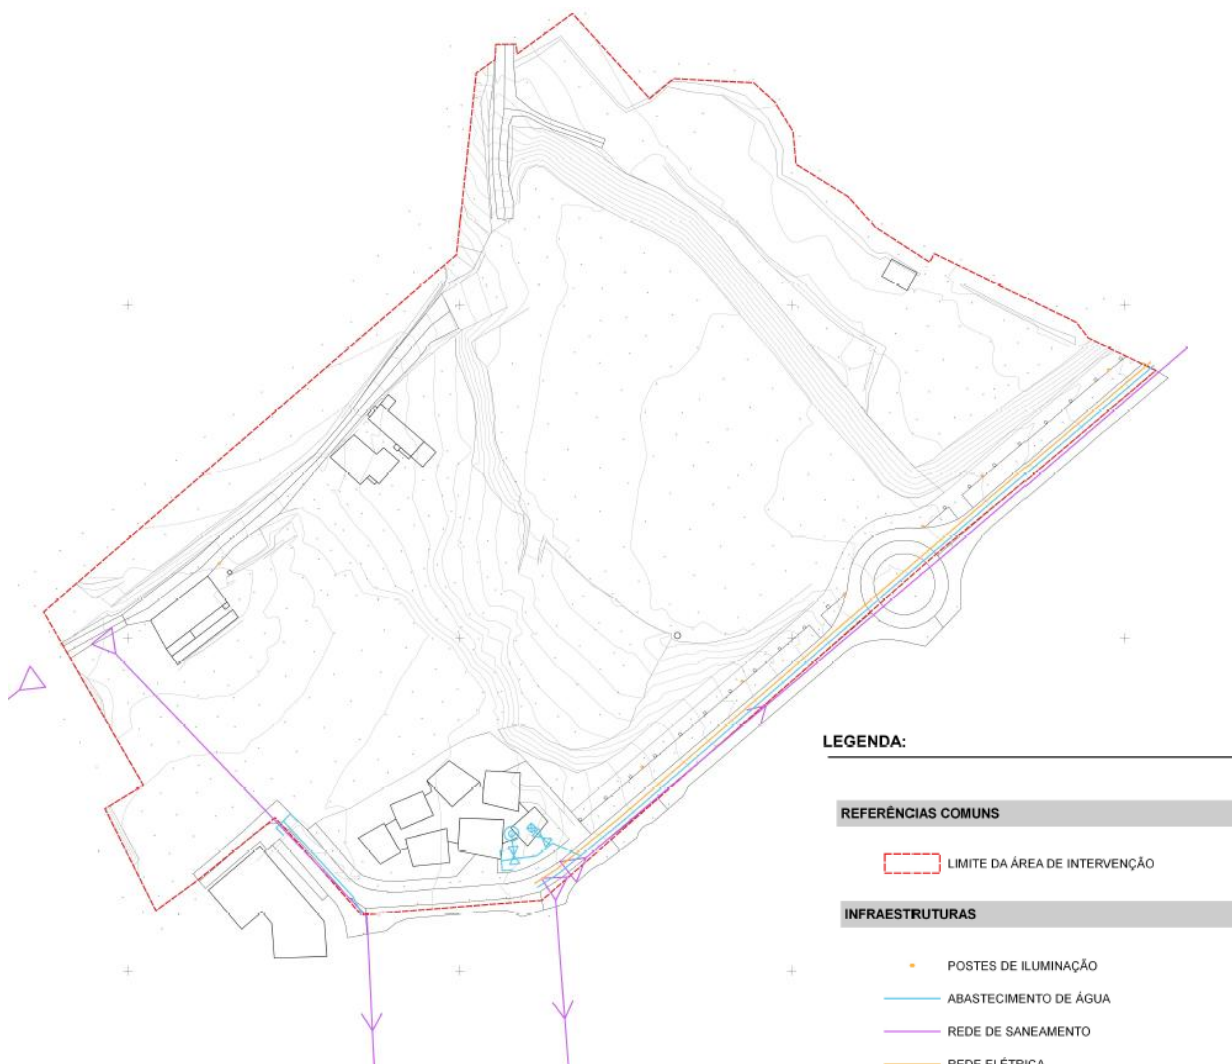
Extrato da Planta de Infraestruturas Existentes– Abastecimento de água | Drenagem de águas residuais | Rede elétrica
